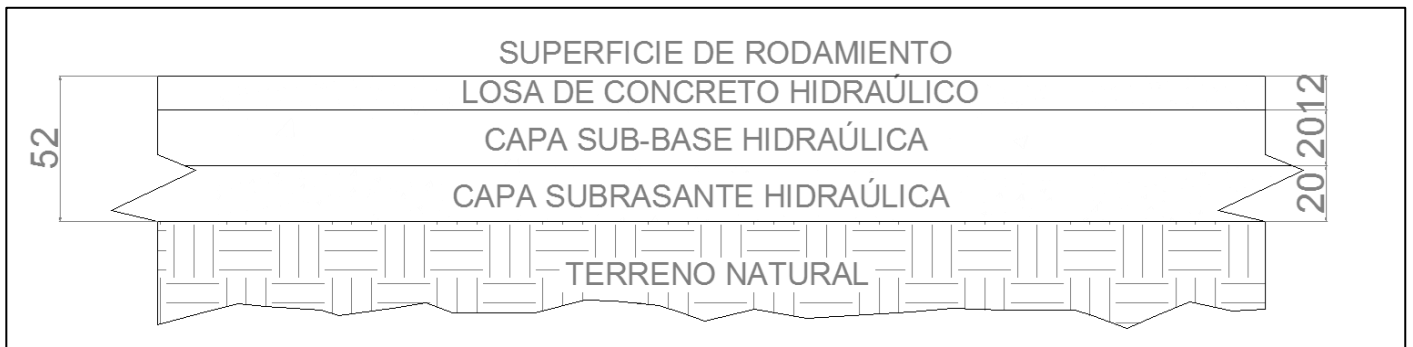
Estructura de Pavimento con capa estabilizada con cal.
